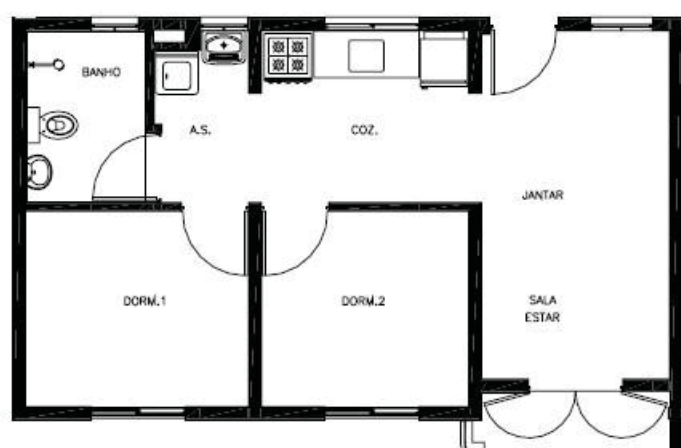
Planta baixa – Ap. de 2 dormitório – Conj. Parque do Gato
